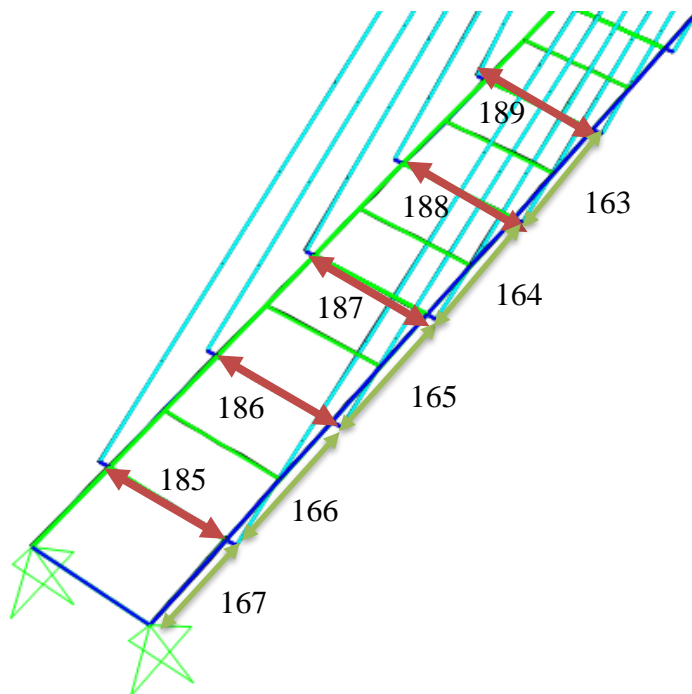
Vigas transversales y longitudinales (5 primeros cables)
